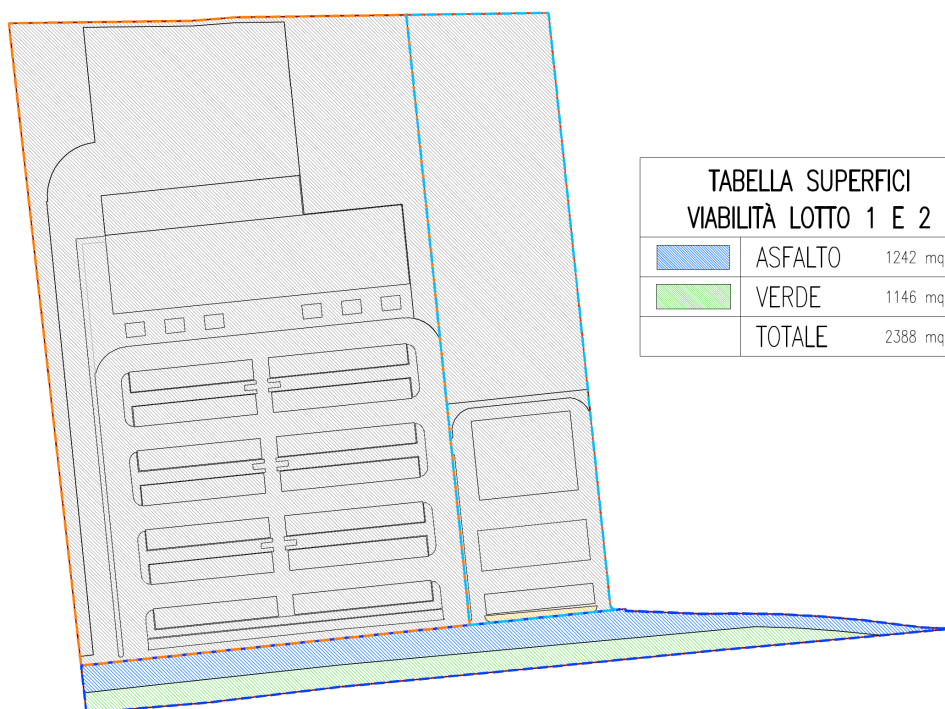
SUDDIVISIONE DELLE DESTINAZIONE D'USO ALLO STATO DI PROGETTO – VIABILITÀ
